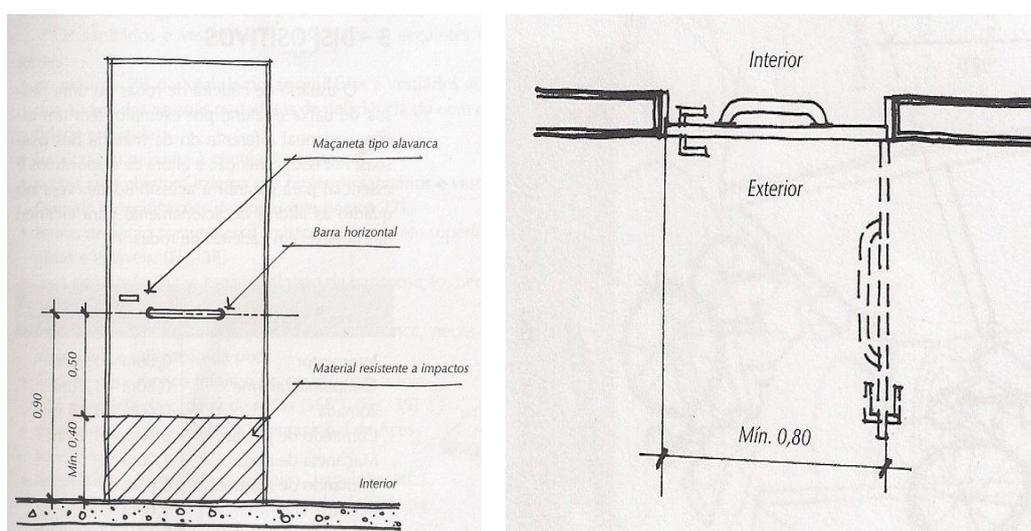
Imagens de uma porta acessível em vista e planta baixa.
